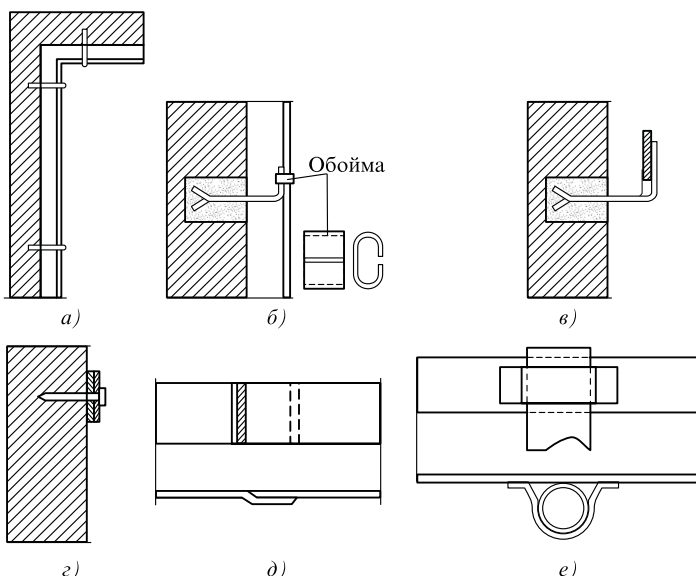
Варианты прокладки (а) и крепления плоских и круглых шин обоймами (б), электросваркой (в) и встраиваемыми дюбелями (з), сваркой внахлестку (д) и приваркой к электроду (е)
